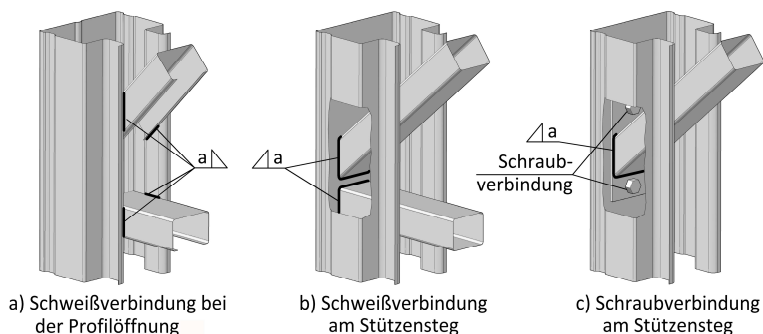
Alternative geschweißte und geschraubte Anschlusskonfigurationen
